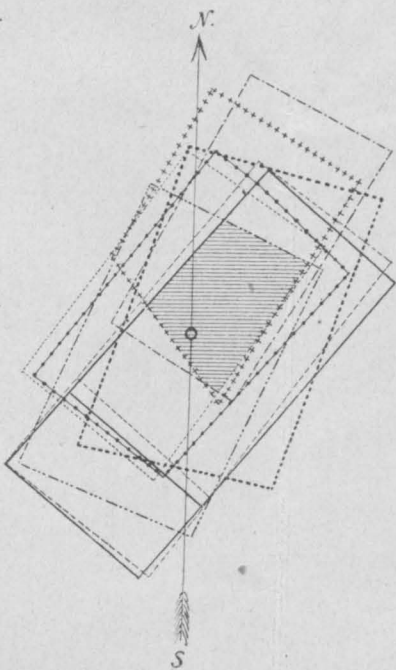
Grundriss des Franzschächter Gebäudes.
